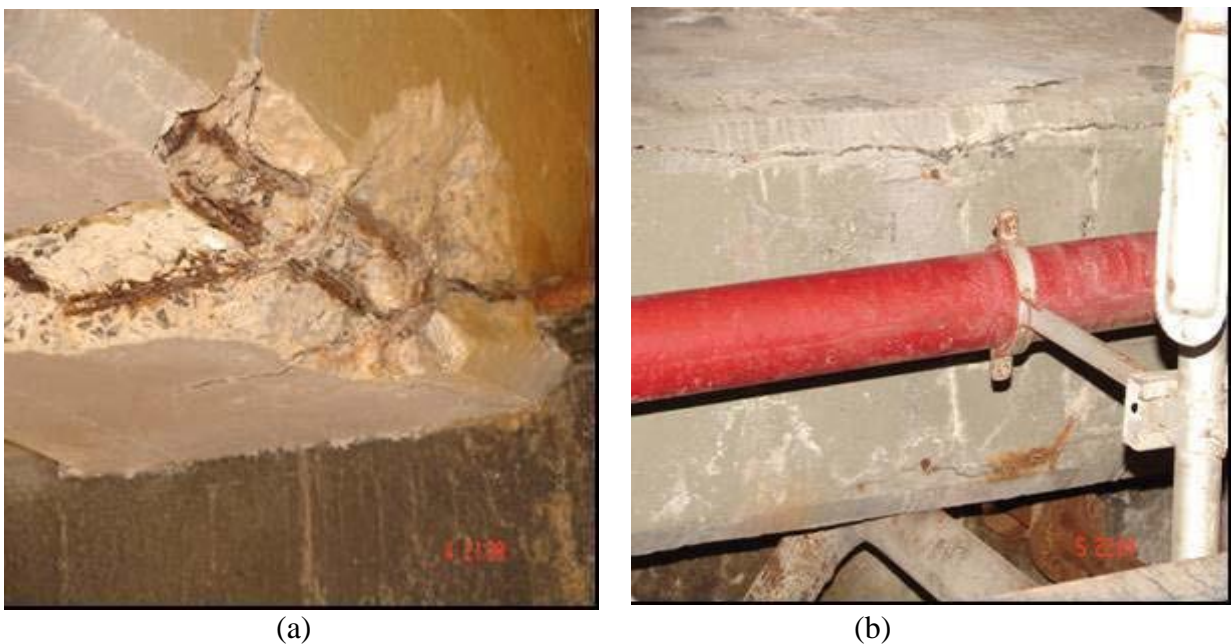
Levantamiento fotográfico de la Cara Sur de dos vigas principales con evidente daños por corrosión. a) Concreto delaminado y acero expuesto, b) Concreto agrietado y manchas por lixiviación
